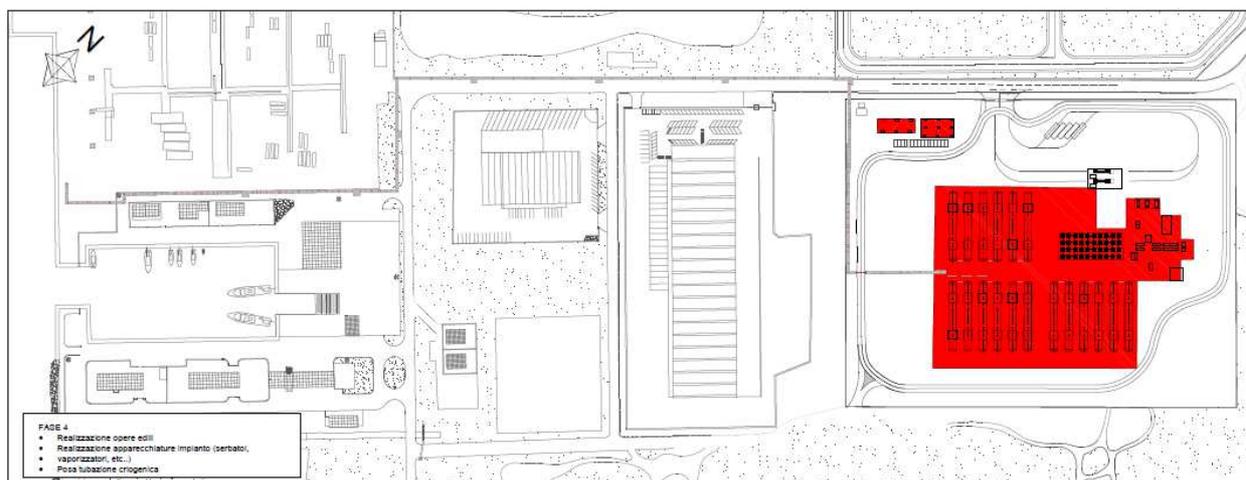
Fase 4 Area oggetto delle lavorazioni previste.
